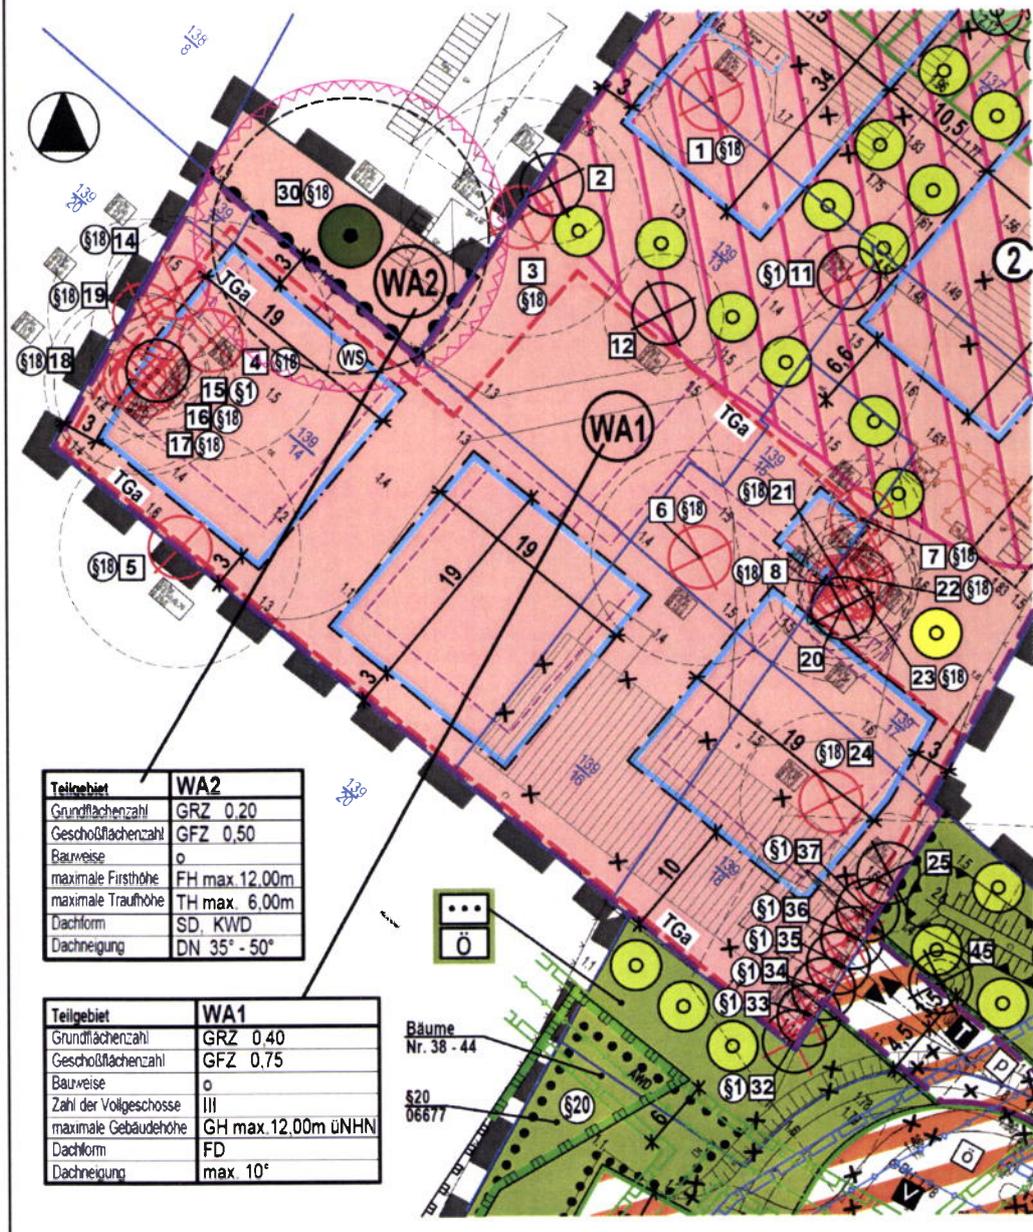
Kronendarstellungen des Baumes Nr. 30 mit 23 m Kronendurchmesser
